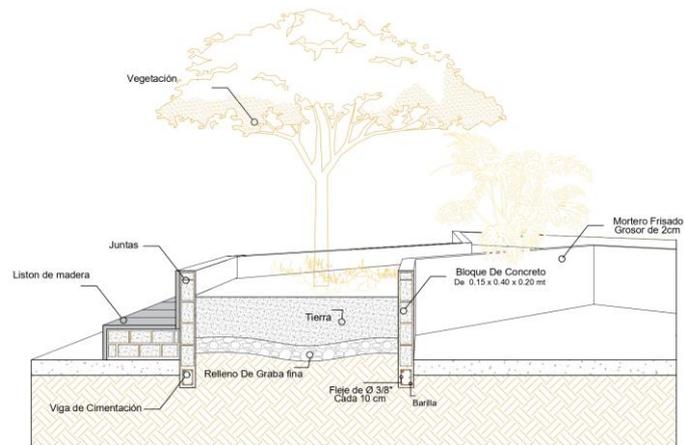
Detalle constructivo de maceteros. Elaboración propia.
